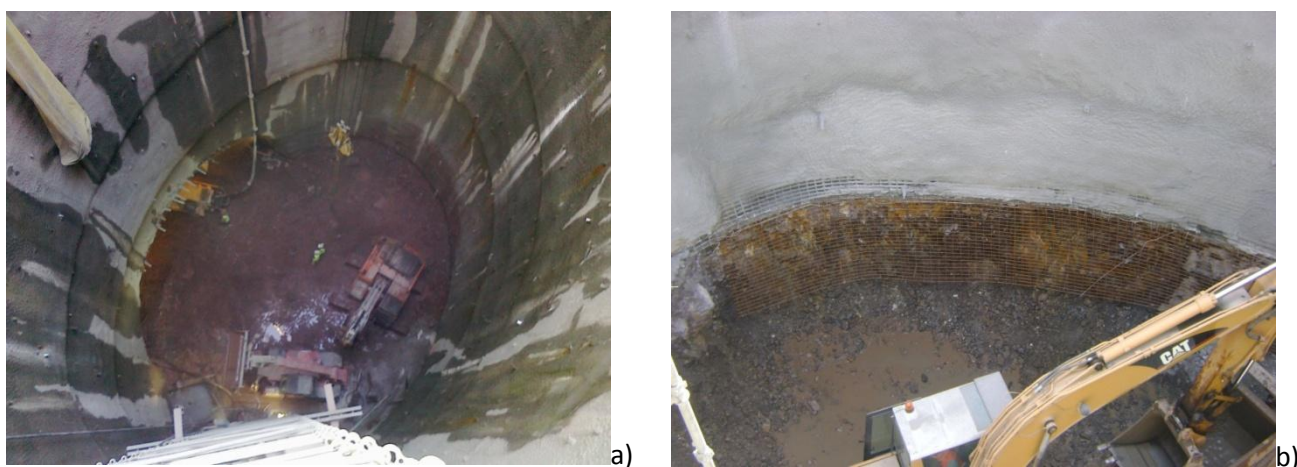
a) Drenos da parede do poço em pleno funcionamento; b) Revestimento primário na parede do poço de ventilação.
